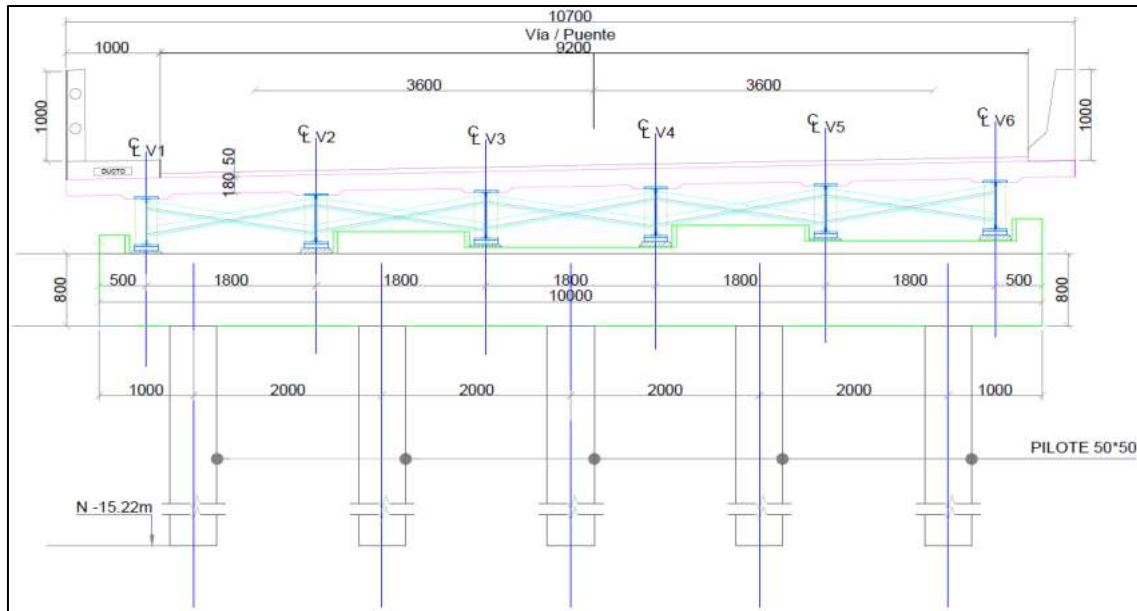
Sección transversal del puente sobre el estero Ñauza
